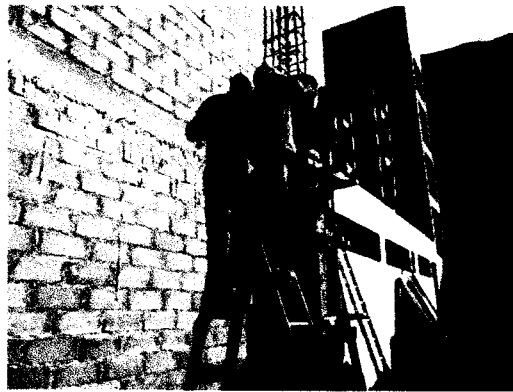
y 36: Concreto $f'c=315$ kg/cm², y encofrado de columnas y vigas. ZONA DE PTAR Y MAESTRANZA.
